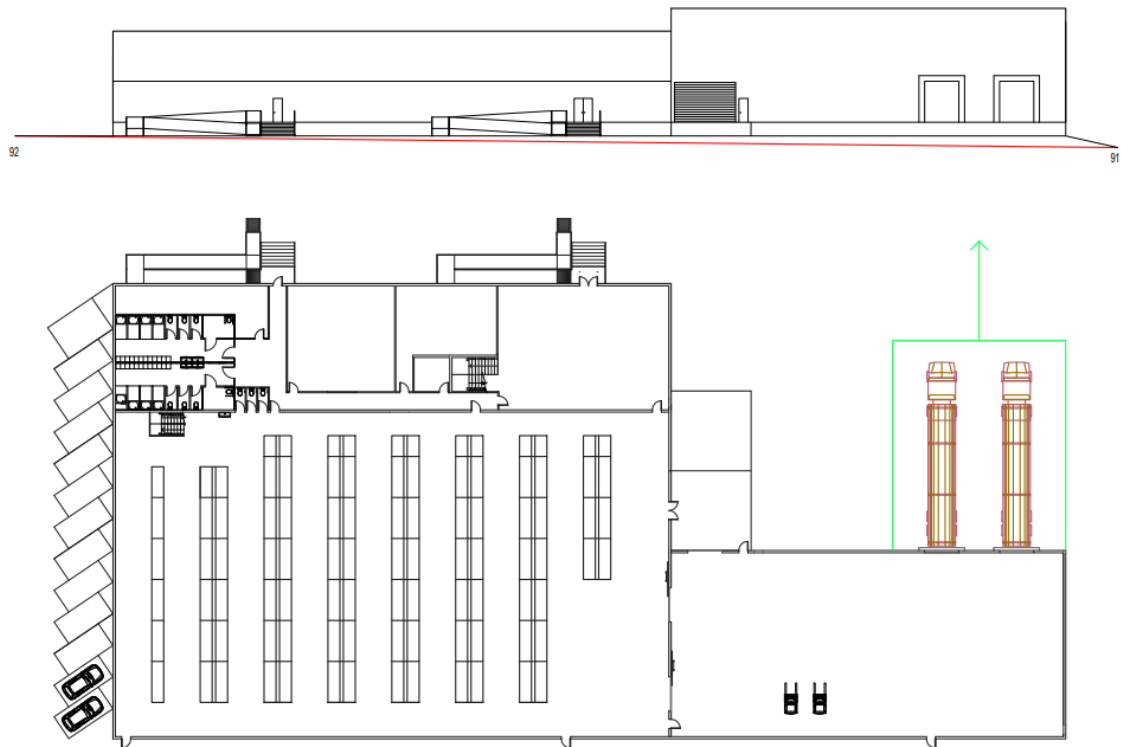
Vista general d'Alçat i Planta. Font: Elaboració Pròpia
